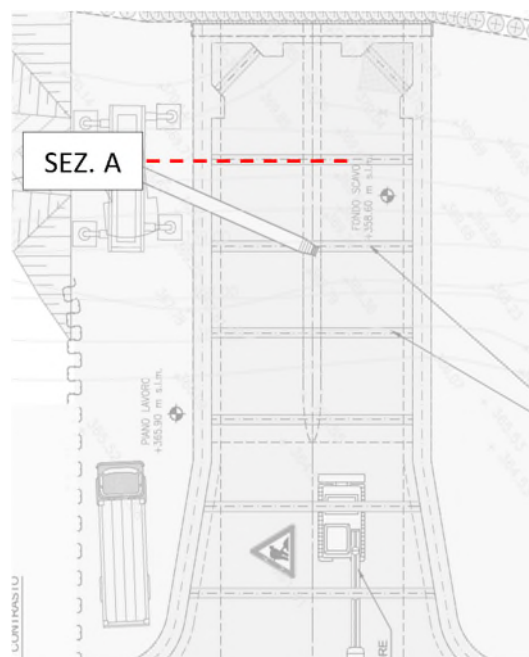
Pali tipo “A1”-“A2” – Pianta - viste e sezioni
